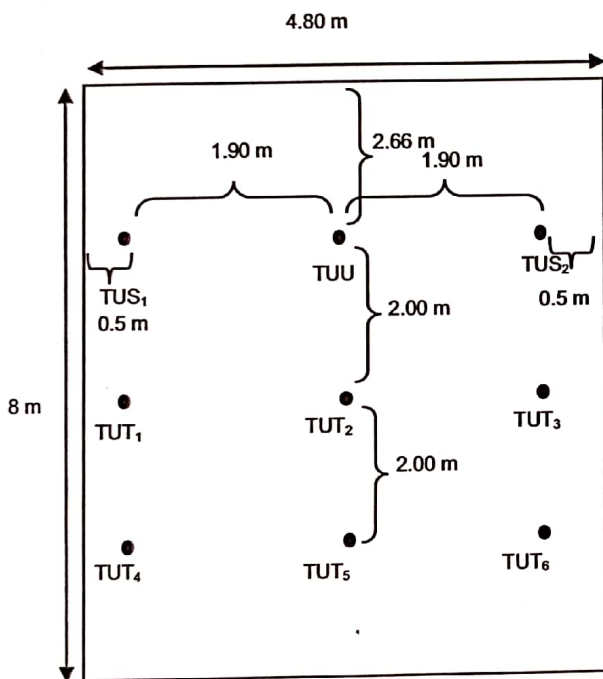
Denah Lubang cahaya dan titik ukur
